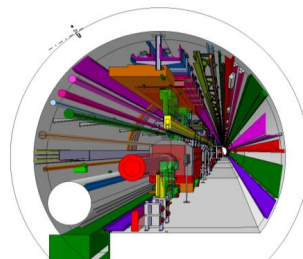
Exemple de section du tunnel avec des éléments non liés au faisceau.
